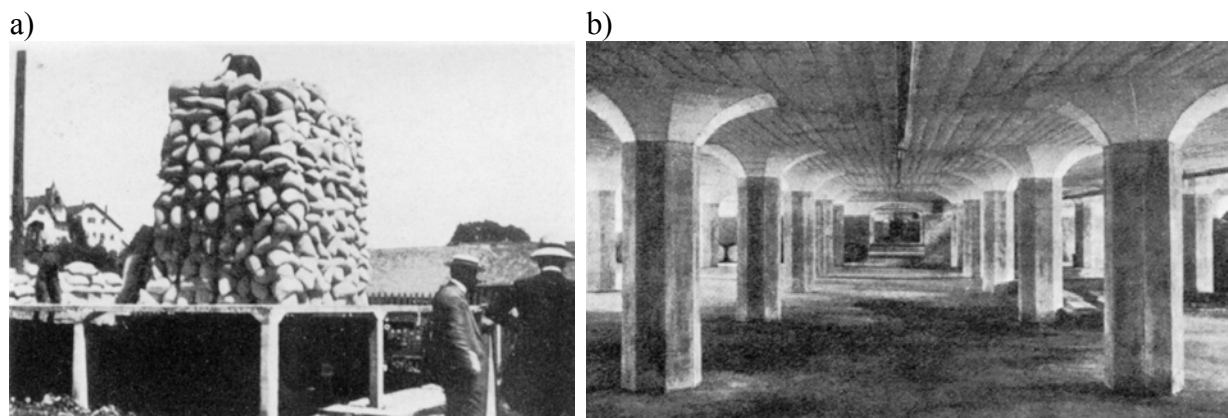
Flachdecken nach Maillart (1926): a) Belastungsversuche, b) Ausgeführte Pilzdecke aus dem Jahr 1910
